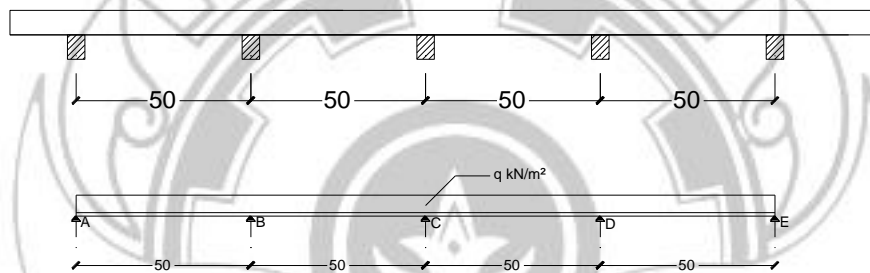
Pemodelan statik pada bekisting lantai tipe tiang perancah
